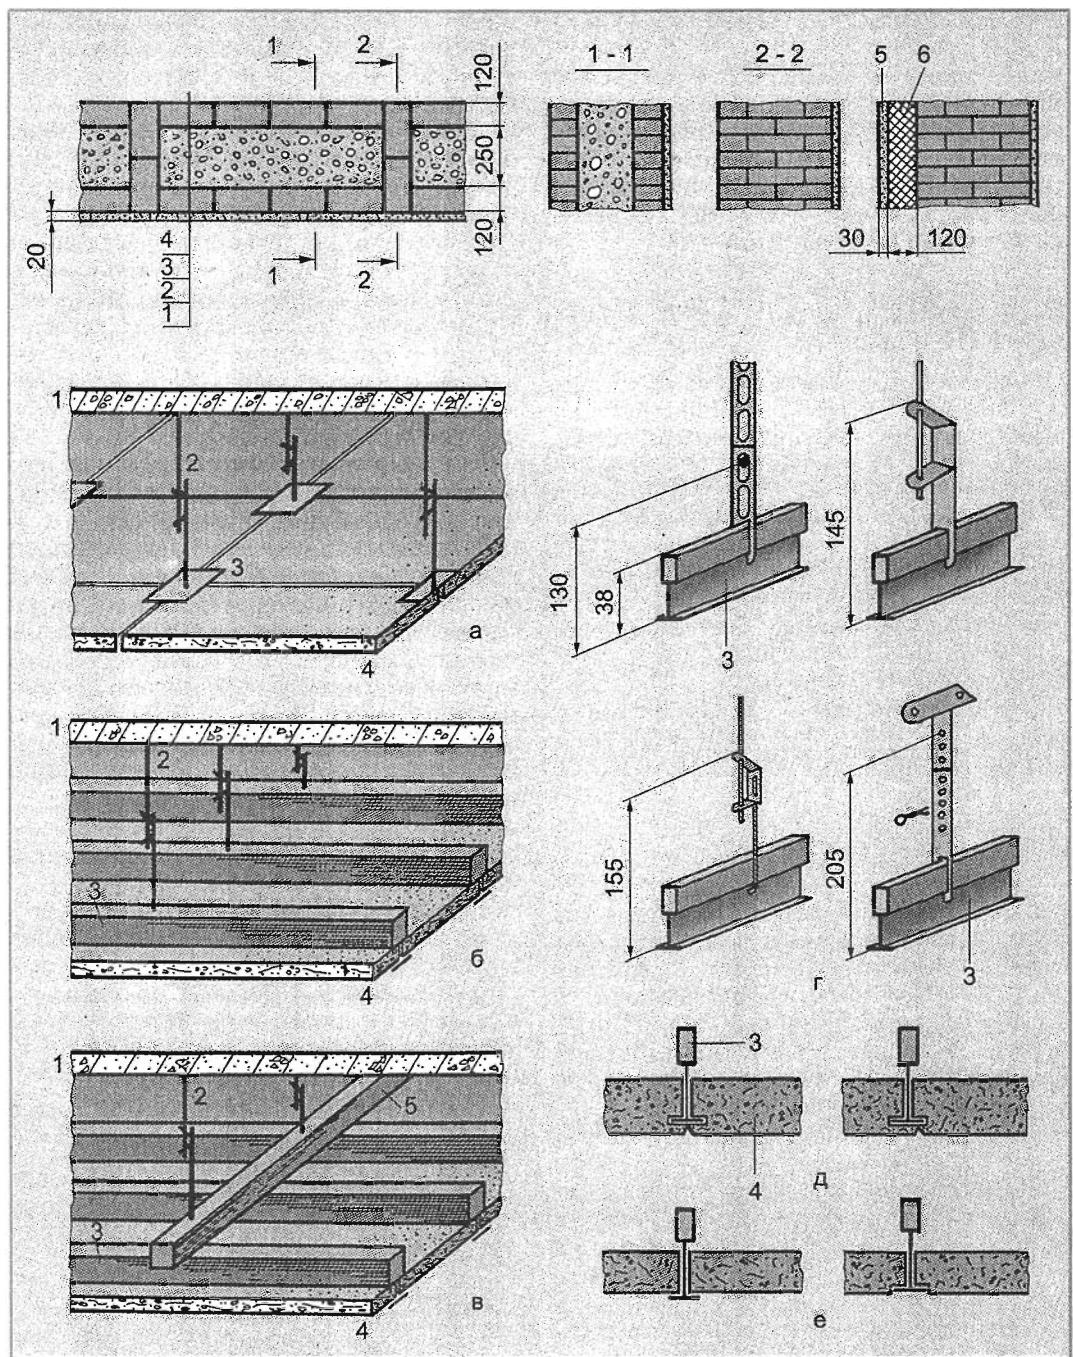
Теплотехнический расчет наружных стен (пример № 3); 1 – известковая штукатурка; 2 – кирпичная кладка; 3 – керамзитобетон; 4 – кирпичная кладка; 5 – паропроницаемая штукатурка; 6 – плитный утеплитель
